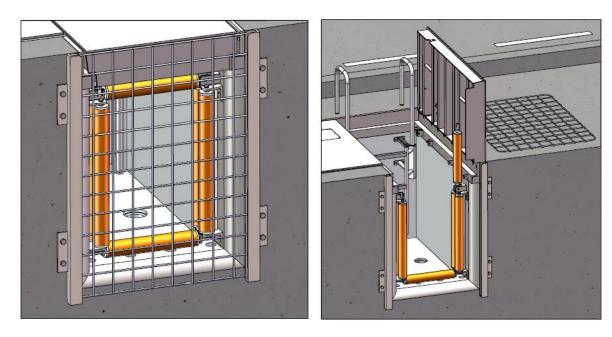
Detalle de la abertura para la conexión de los cables (Fuente: Cavotec)
